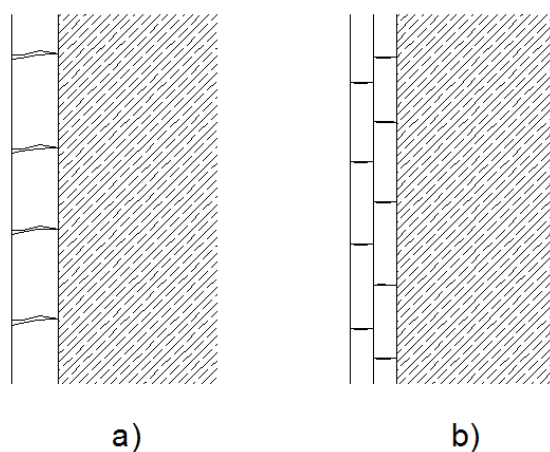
a) Reboco numa única camada fissurada; b) Reboco aplicado em duas camadas, citado em [4].
